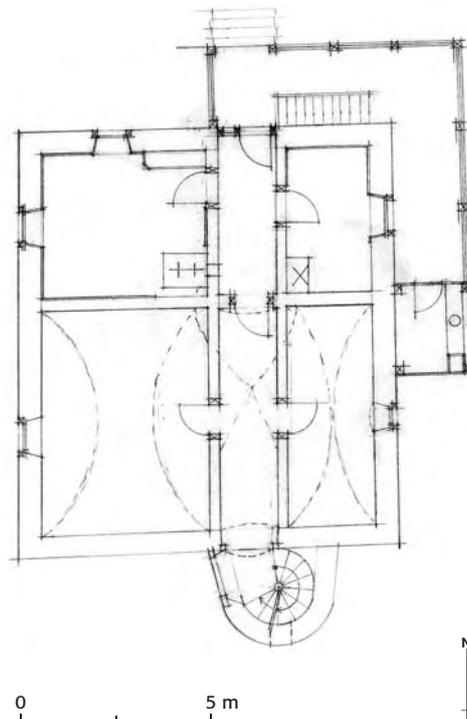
Trimmis, Haus Nr. 285 (Schlössli). Aufnahmeplan Grundriss Erdgeschoss. Mst. 1:200.
